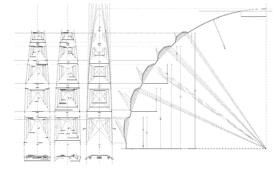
Alzado de los sectores correspondientes a los dos extremos del eje de la entrada y alzado y sección de un sector ideal generado a partir del estudio de las alineaciones de los casetones levantados mediante fotogrametría
